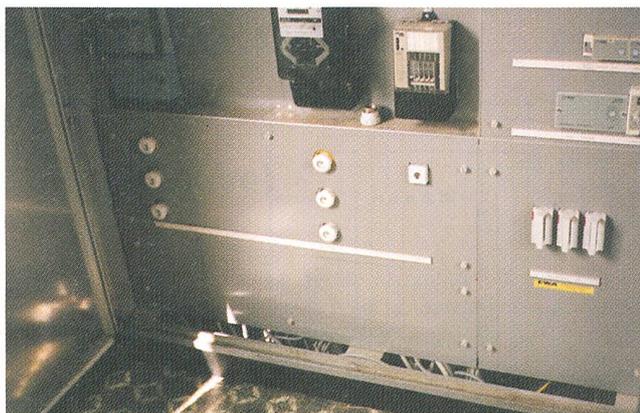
Plaque de recouvrement non-partagée: une fois retirée, les pièces sous tension ne sont pas recouvertes
